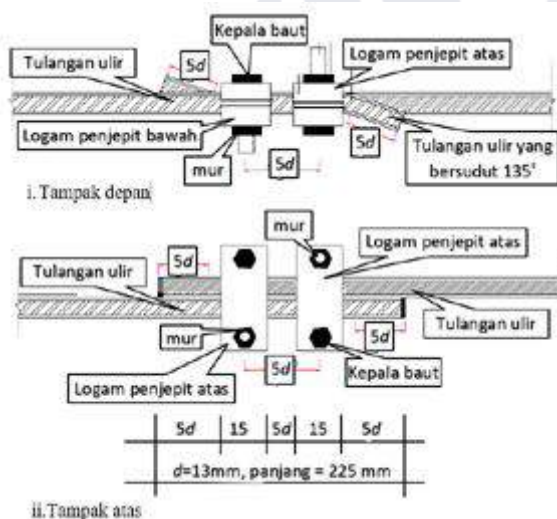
Tampak sambungan mekanik jepit mur dan baut pada baja tulangan beton ulir D13 bersudut 45°
